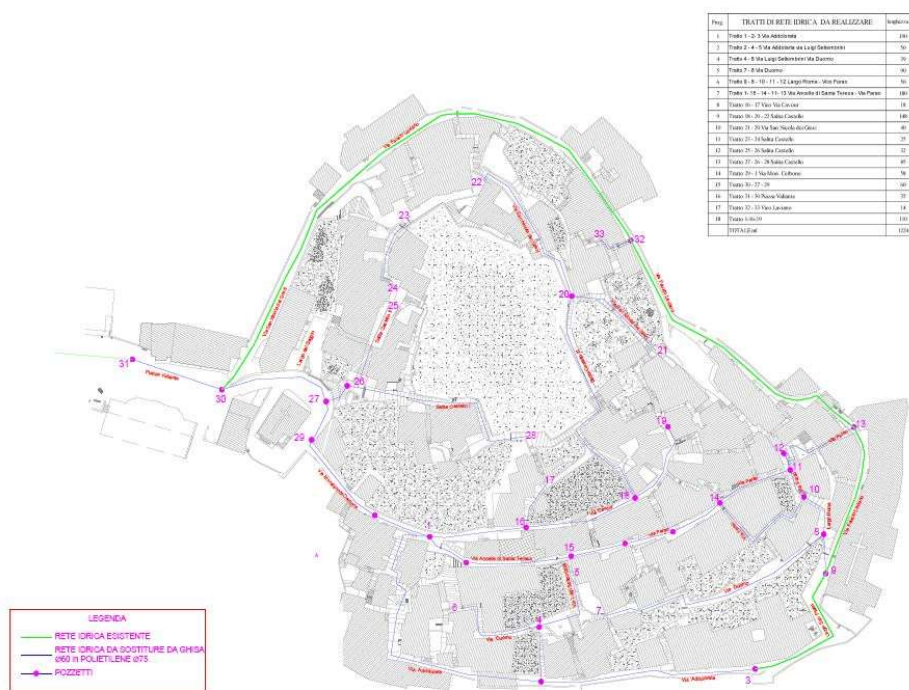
Stralcio della planimetria della rete idrica esistente e di progetto
